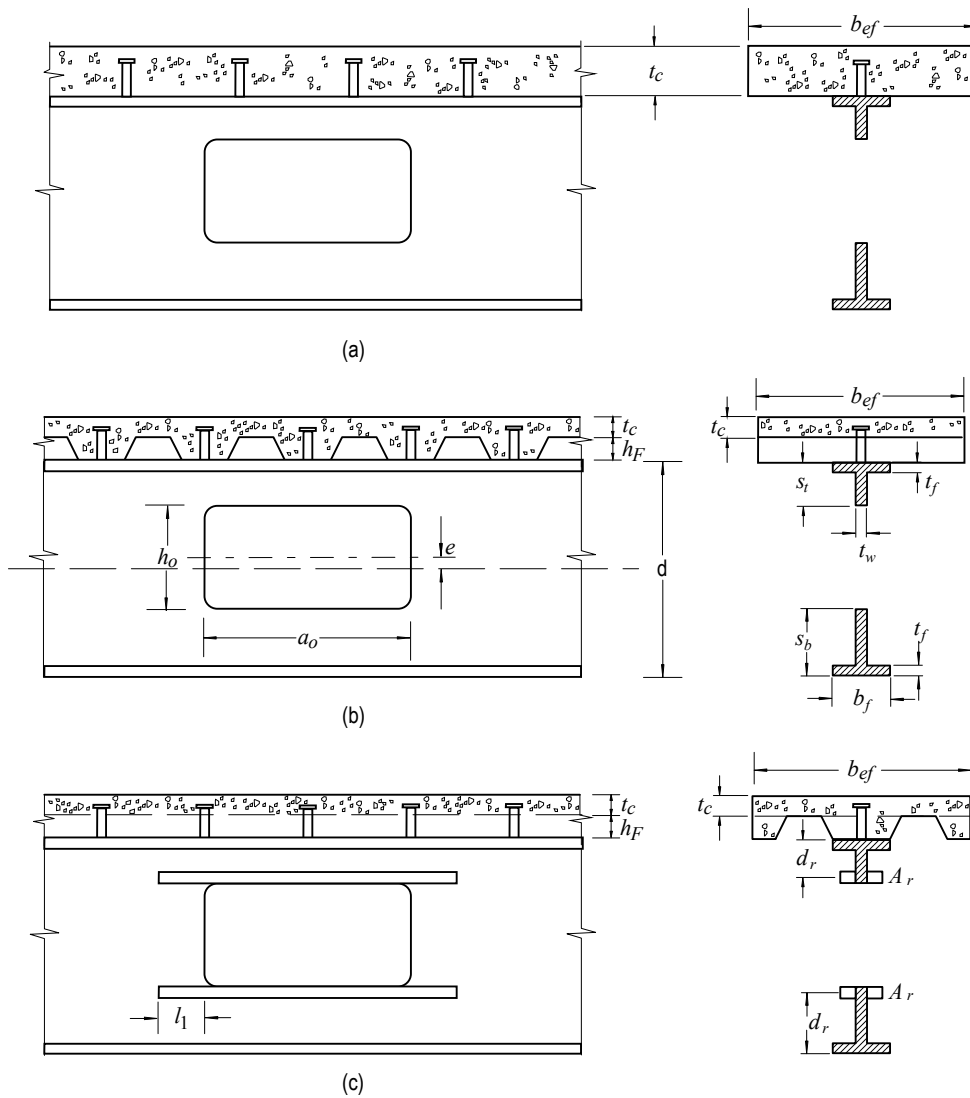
Configurações de aberturas em vigas mistas. (a) abertura não-reforçada, laje maciça, (b) abertura não-reforçada, laje nervurada com nervuras transversais, (c) abertura reforçada, laje nervurada com nervuras longitudinais.
